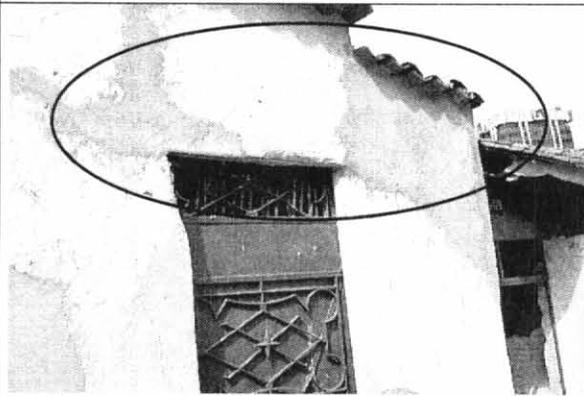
Algunos muro exteriores tienen deformaciones laterales evidentes, pero sin afectar la estabilidad de este sector.
